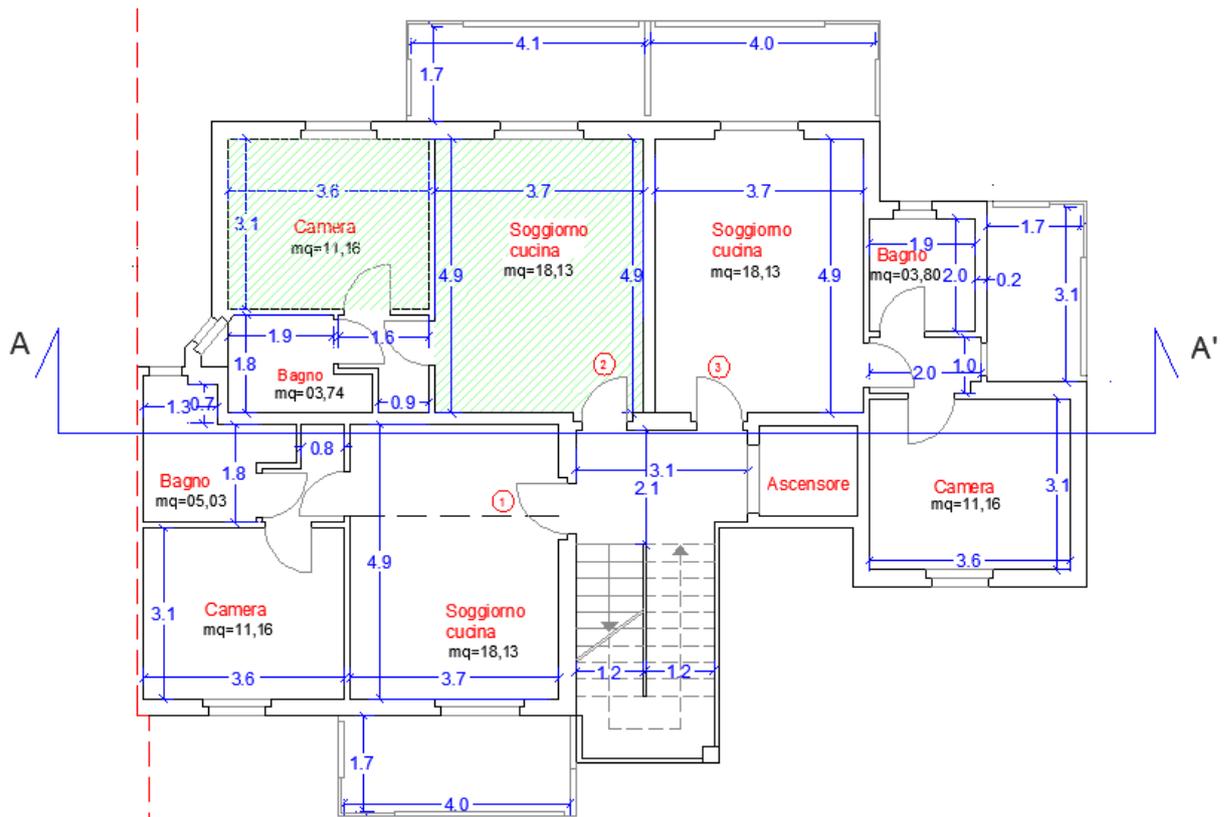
Pianta piano tipo dell'edificio oggetto di studio con individuazione unità immobiliare.
